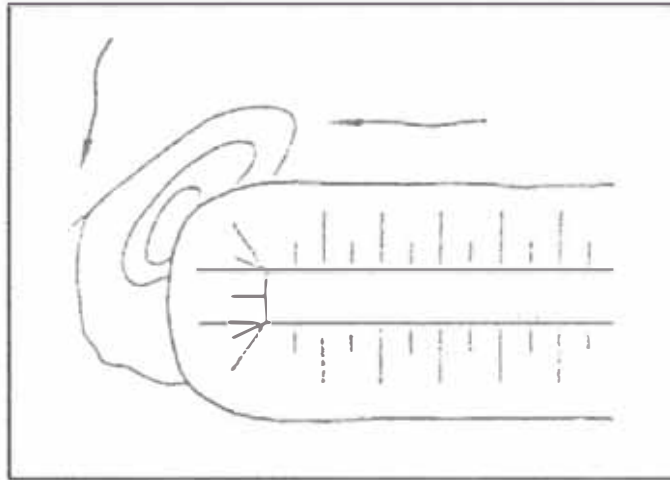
Esquema en planta de la erosión local en un estribo
